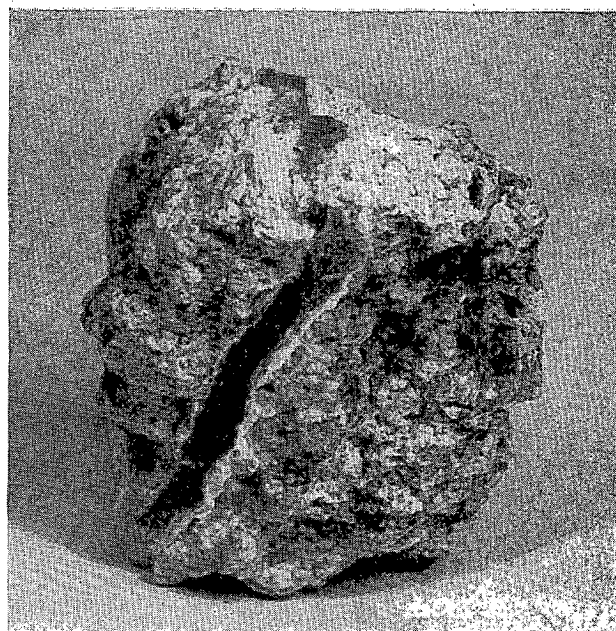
Muestra de granito con una diaclasa (de 8 mm.) inyectada con lechada de cemento.
